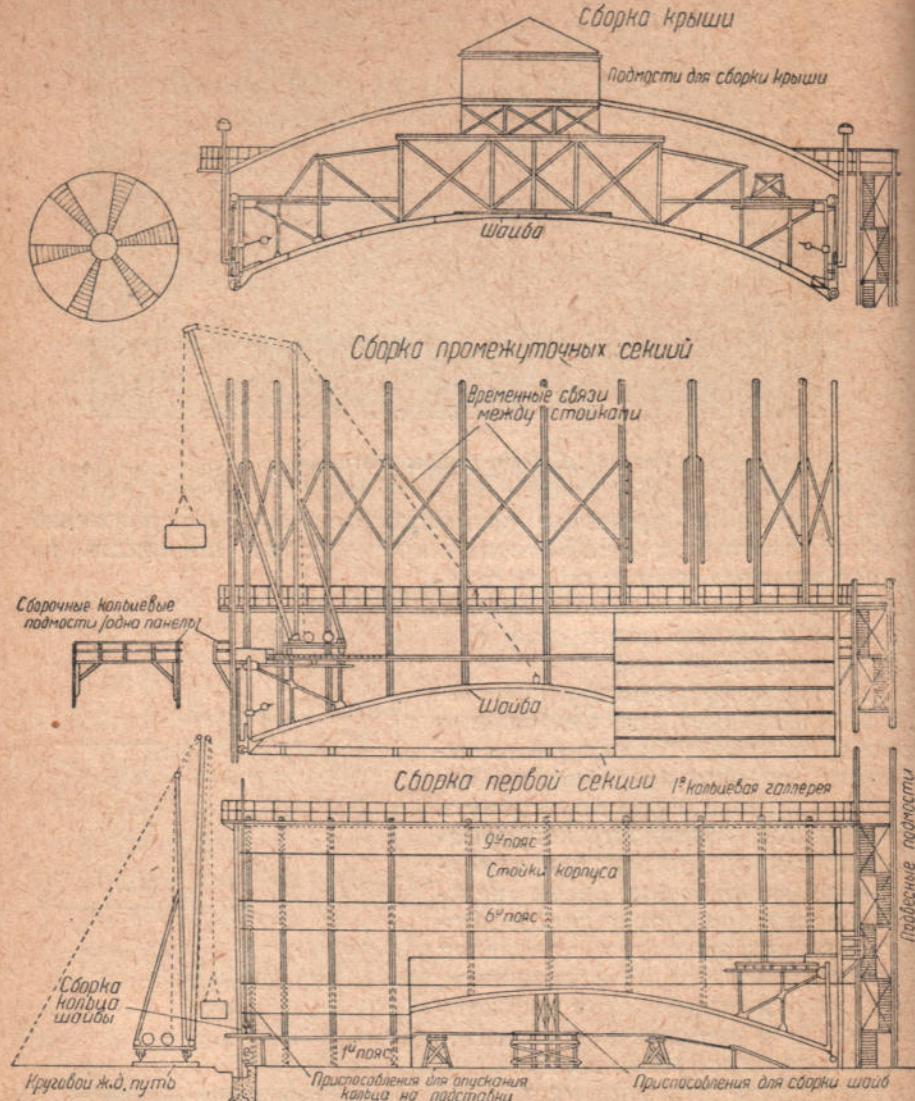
Сборка крыши и промежуточных секций газгольдера
